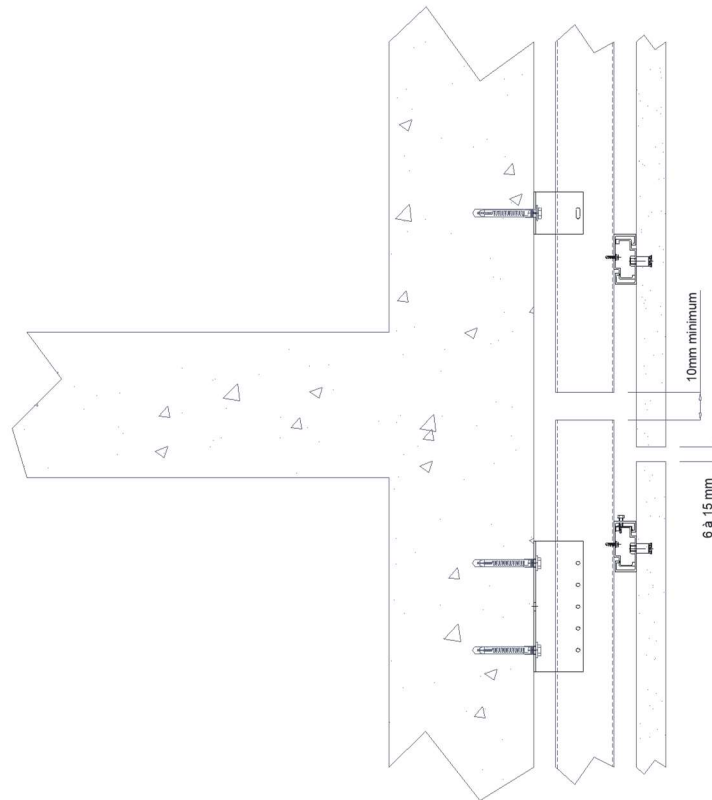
Fractionnement au droit de chaque plancher sur COB
